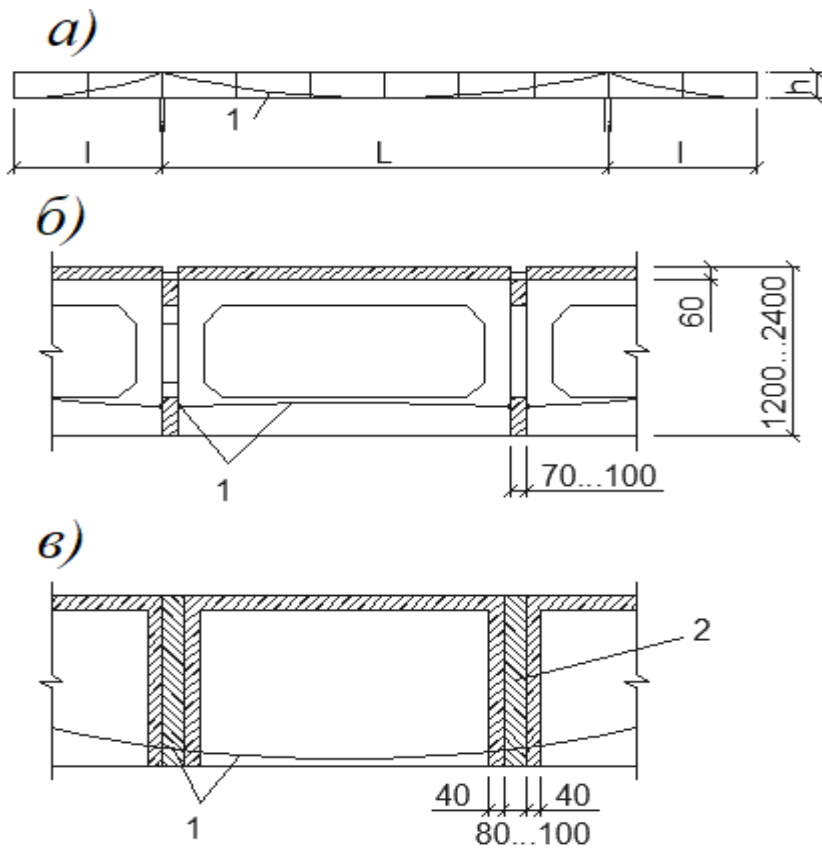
Перехресно-ребриста залізобетонна конструкція:
